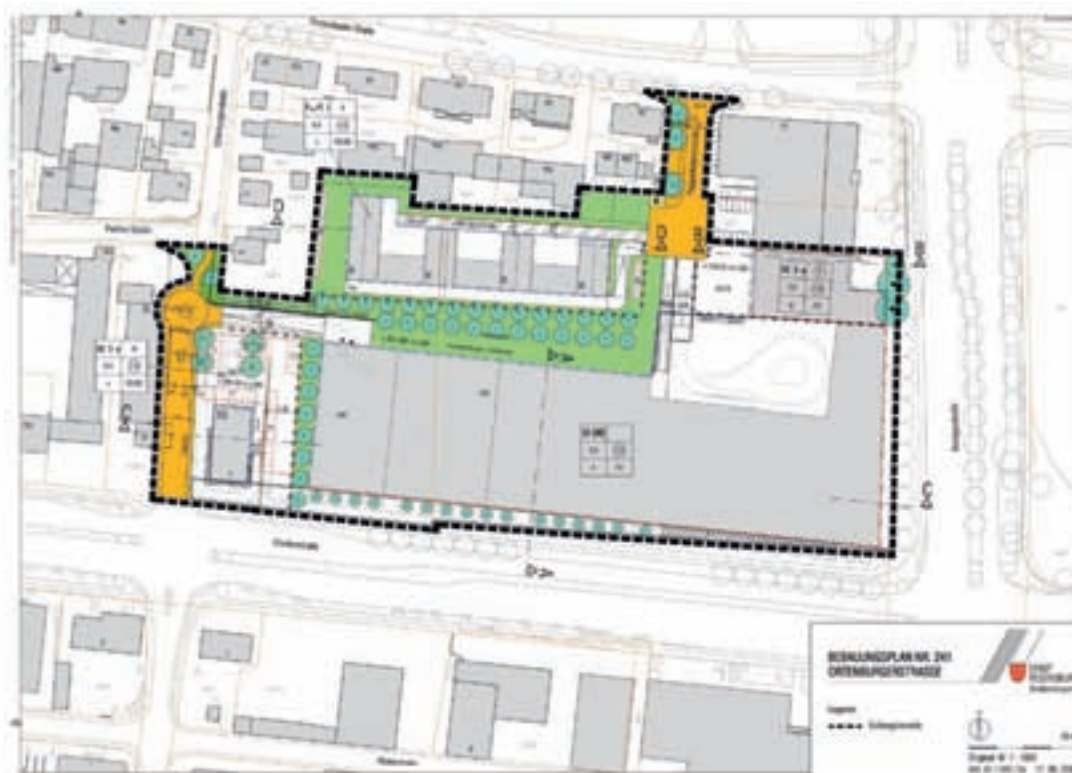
Bebauungsplan Nr. 241 „Ortenburger Straße“ (Rechtskraft: Juni 2009)
